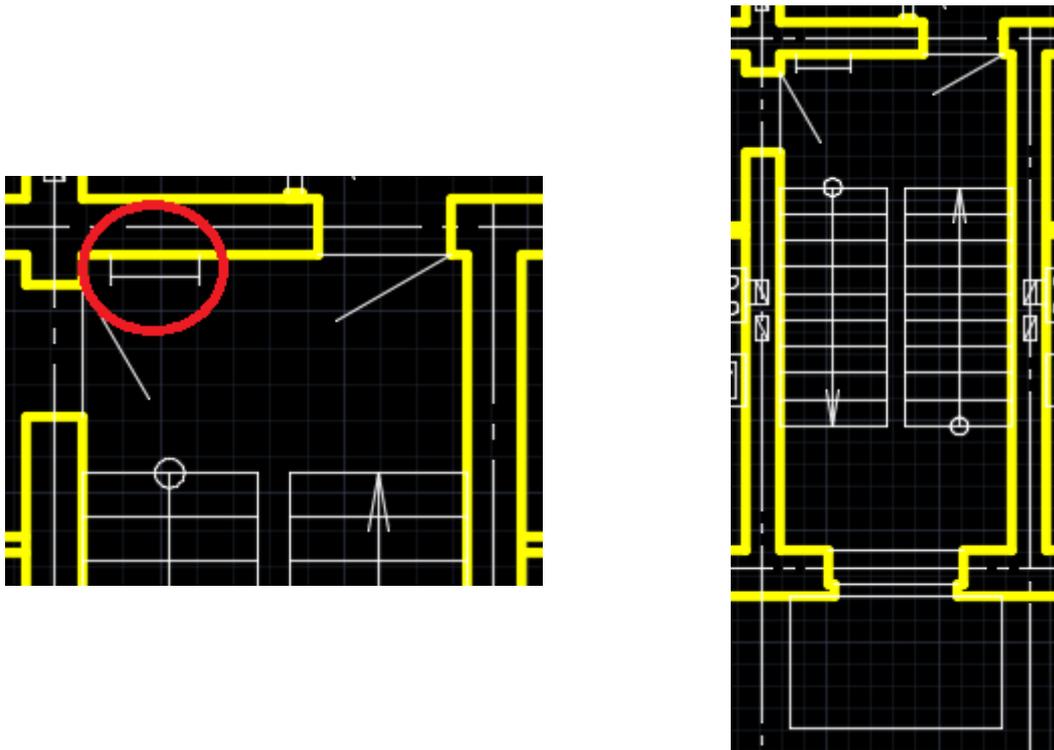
Изображение лестничной клетки для плана второго этажа здания
